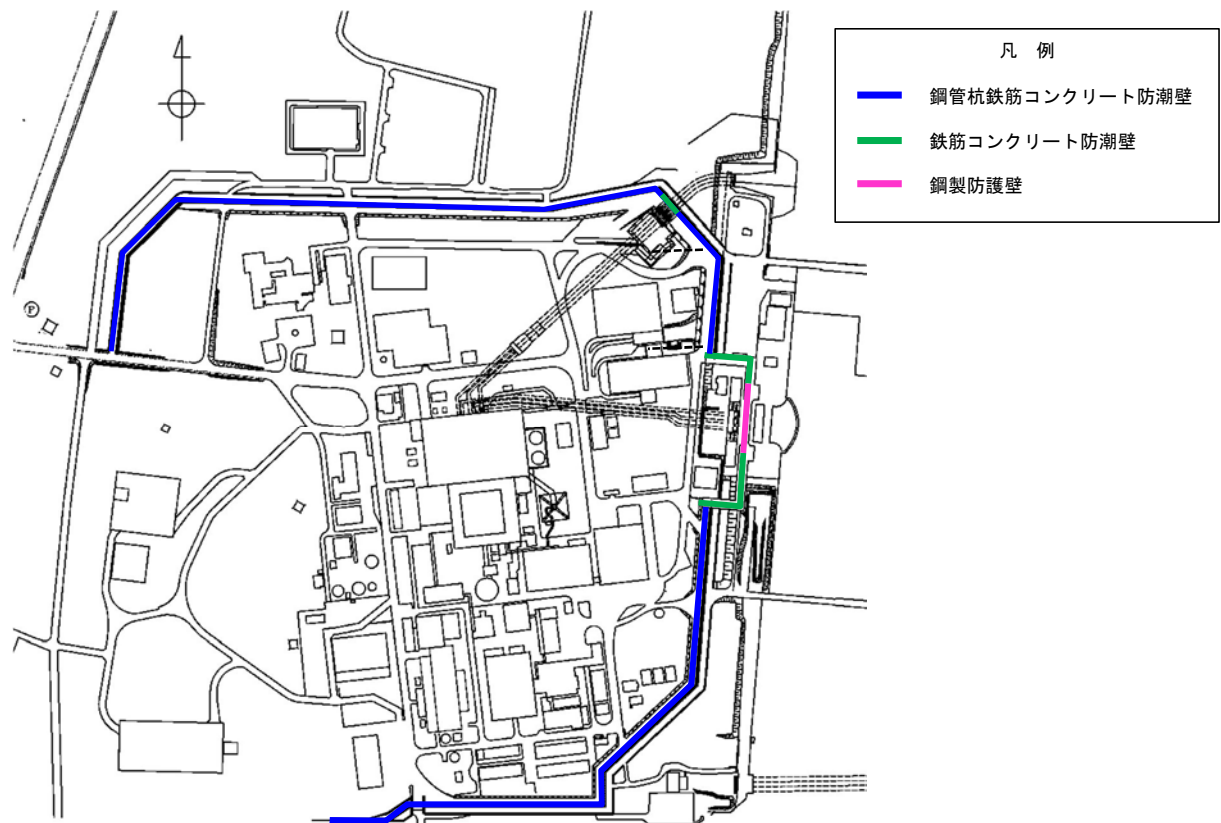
鋼管杭鉄筋コンクリート防潮壁の位置図
